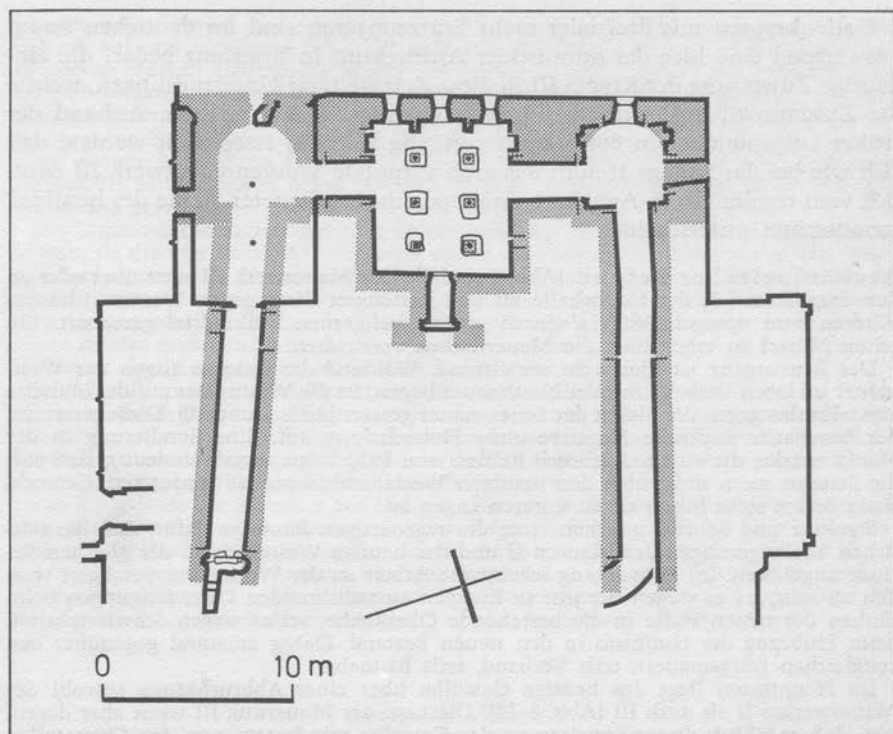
Grundriß der Krypta III, Maßstab 1:400.
